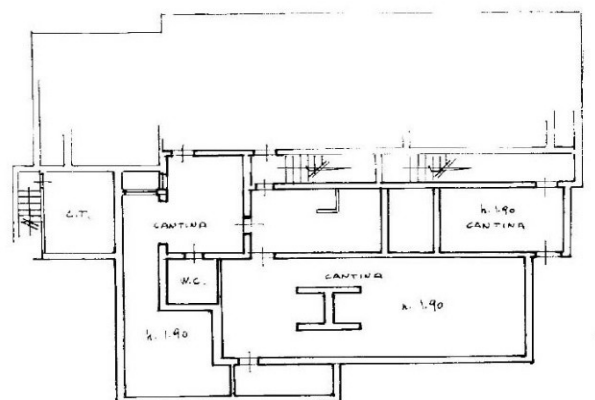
Stralcio plan. Catastale subalterno 4
